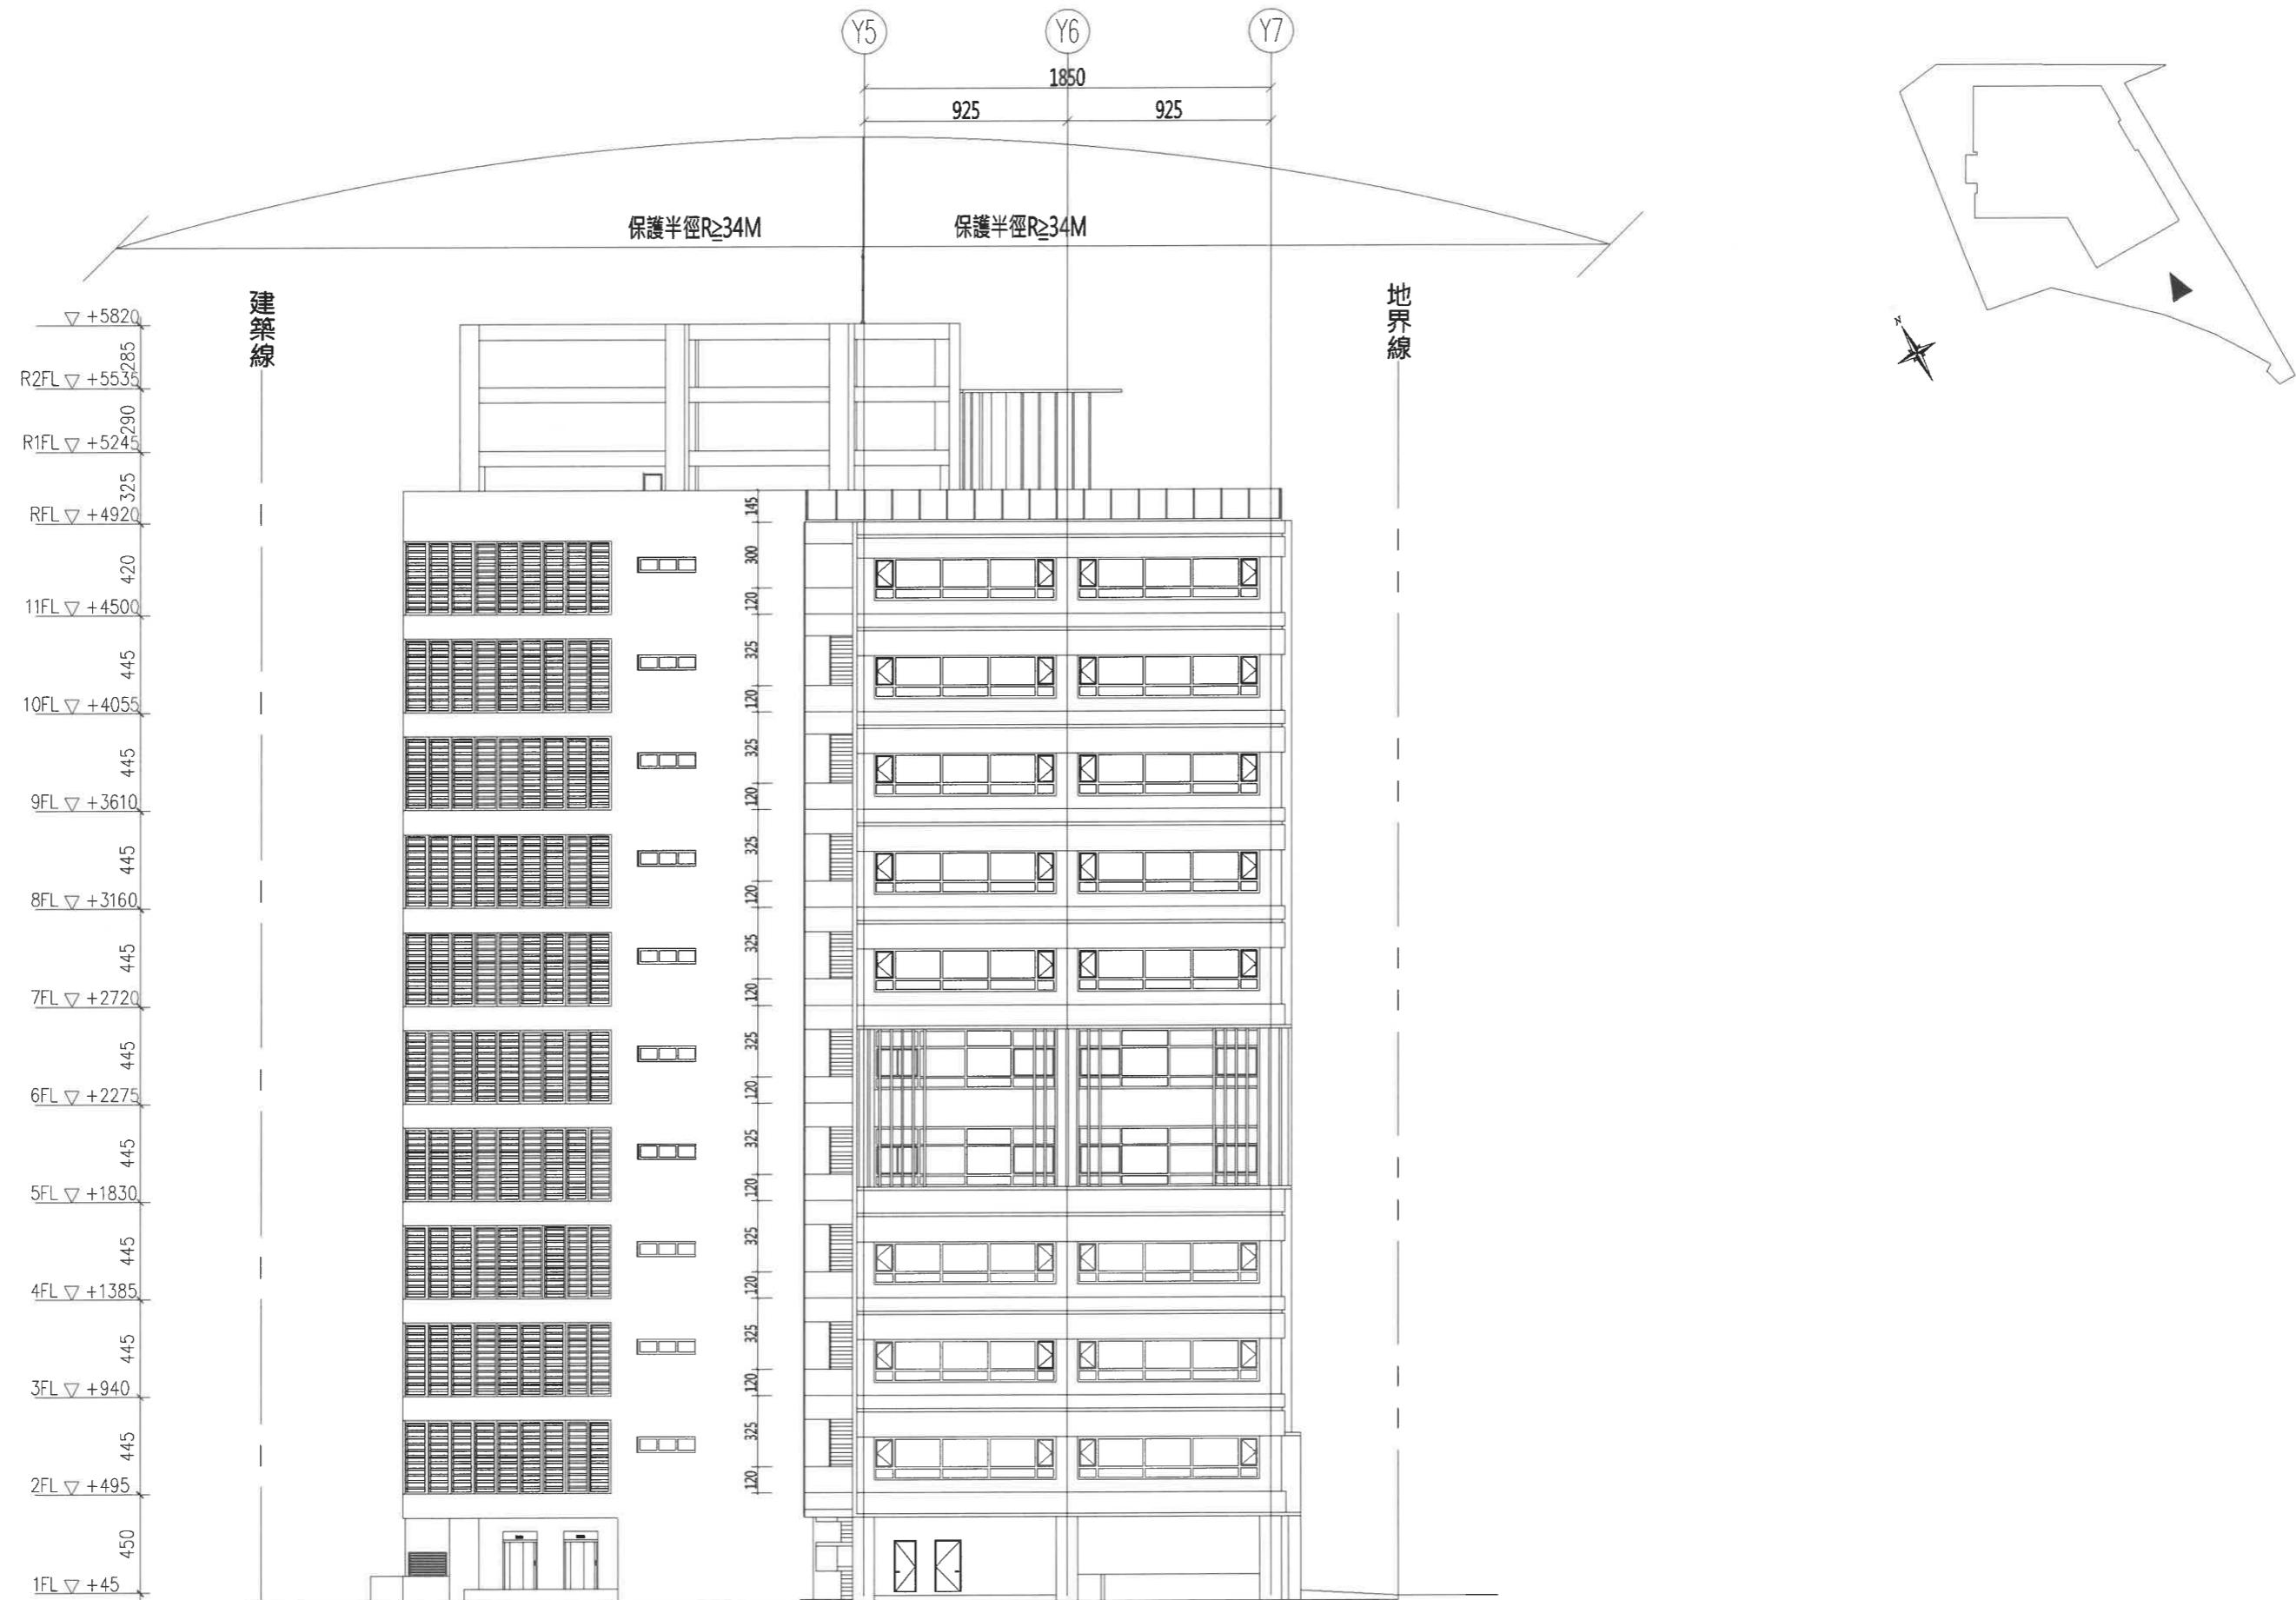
南向立面圖(維持原核定)(S : 1/300)
